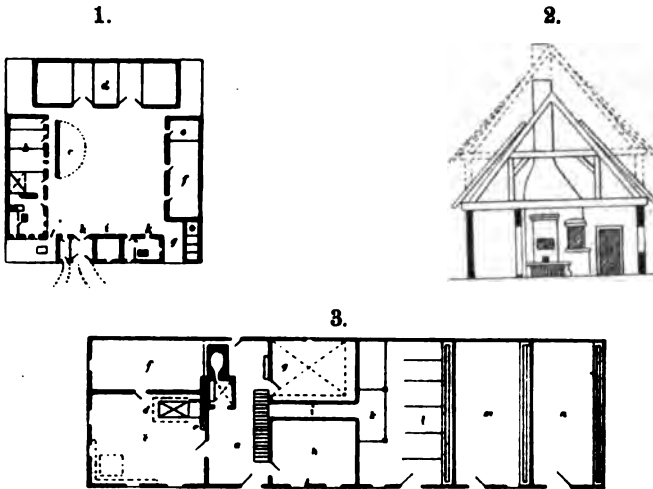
1. Grundriß der fränkischen Hofanlage. 2. Aufriß des oberdeutschen Hauses. 3. Grundriß des oberdeutschen Hauses. Nach A. Reichen.
